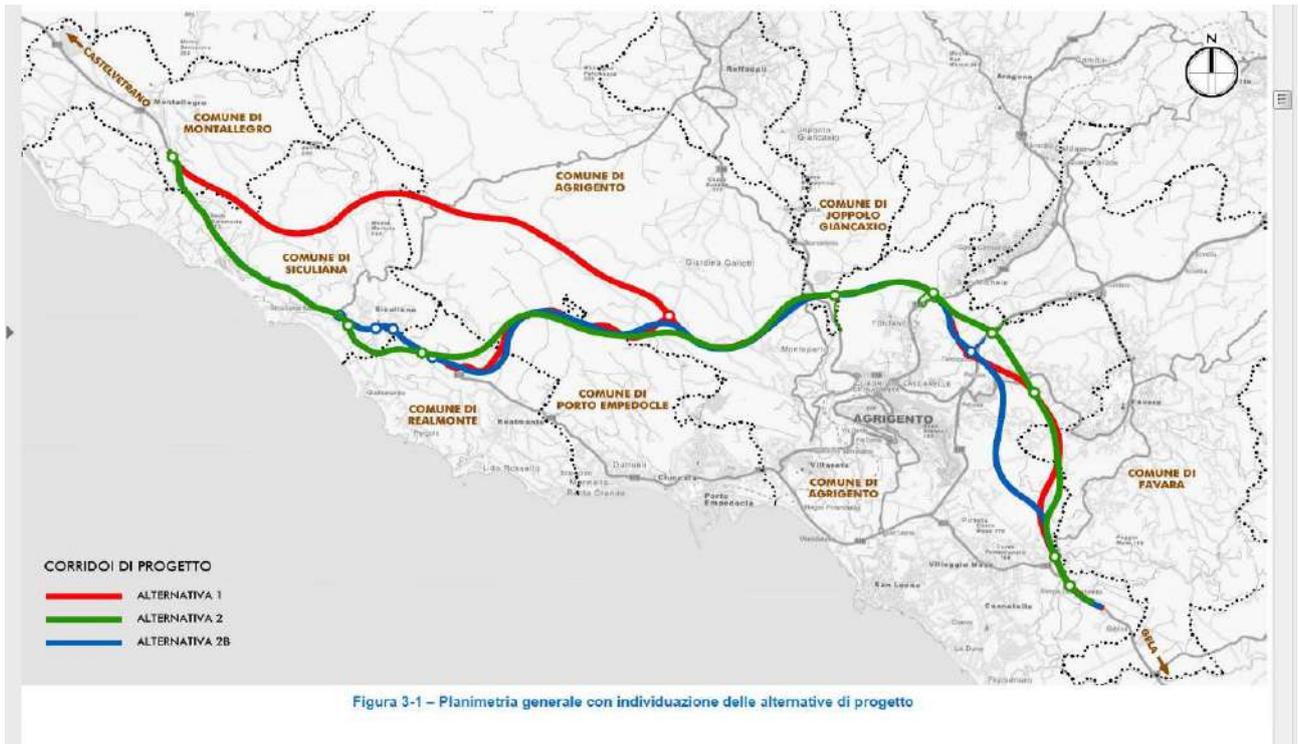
Planimetria generale con individuazione delle alternative di progetto
